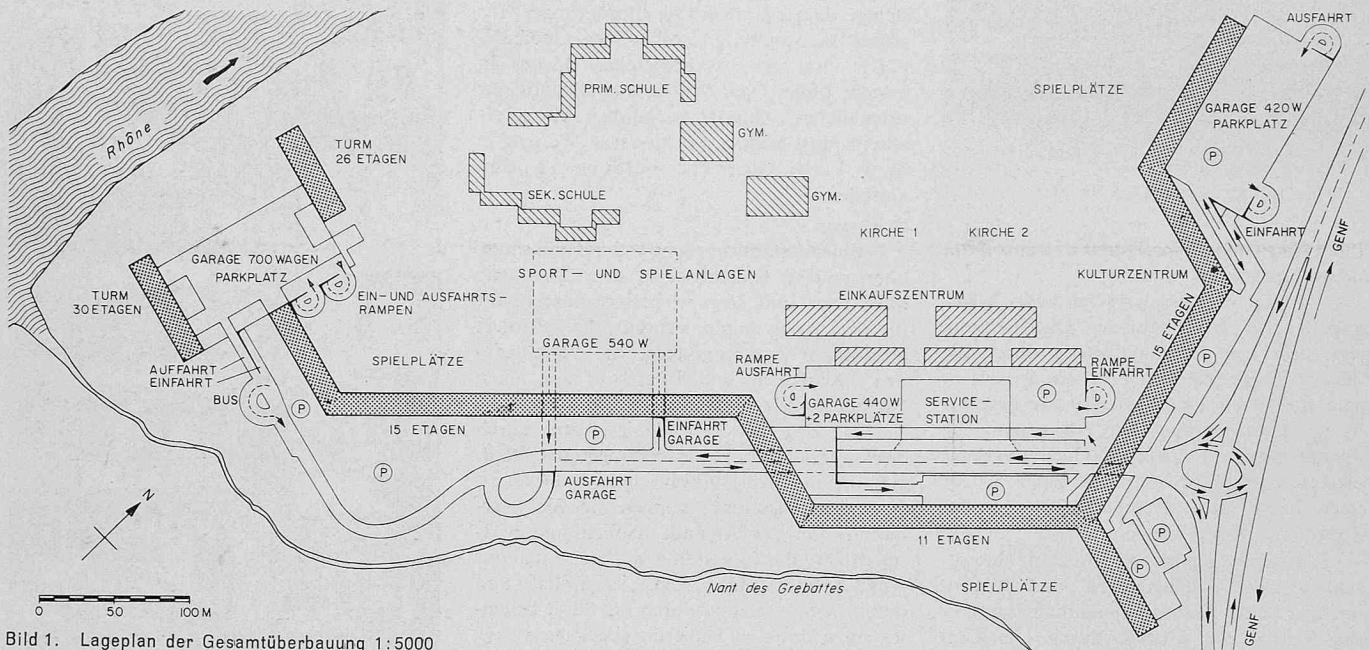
Lageplan der Gesamtüberbauung 1:5000
